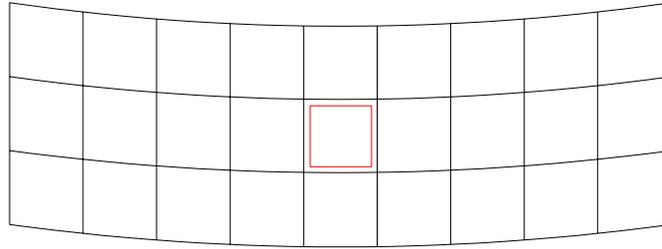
Deformabilidade por insuficiência do contraventamento
